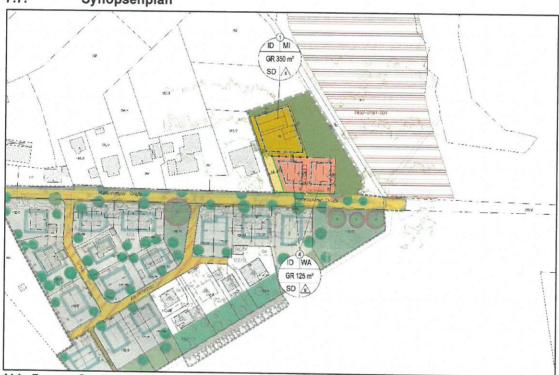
Synopsenplan mit Einarbeitung der 3. Änderung und Erweiterung
